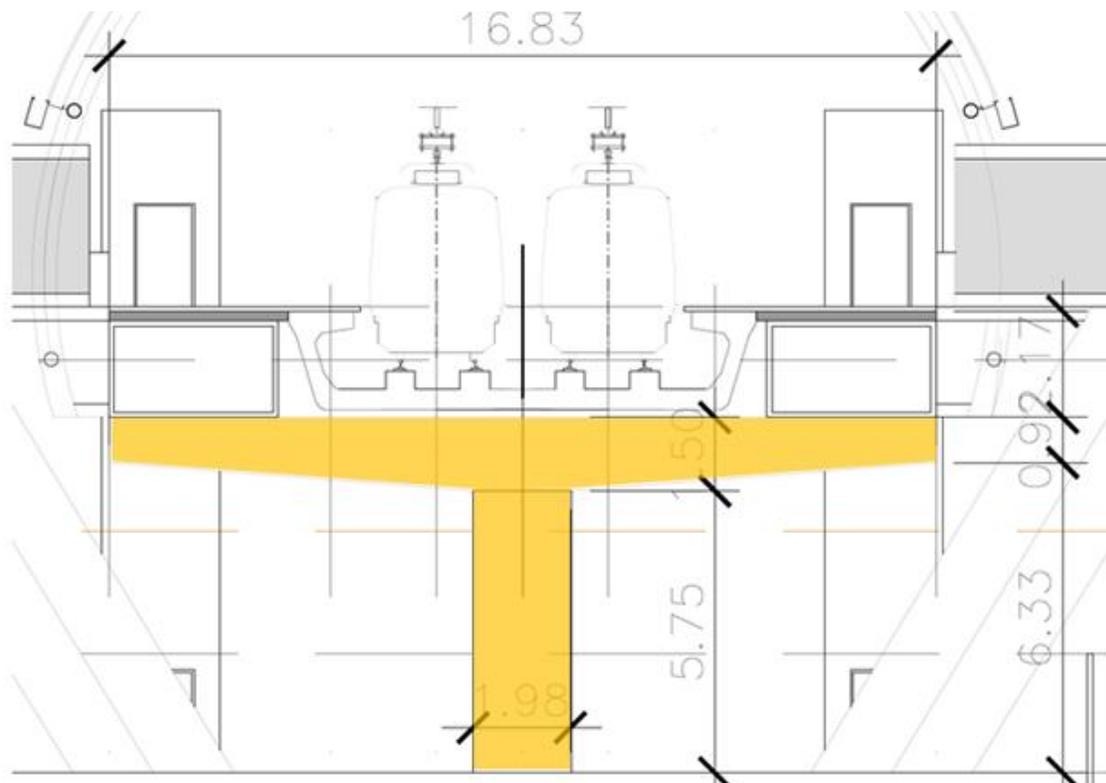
Detalle de estructura del cajón y capitel extendido de la estación elevada
